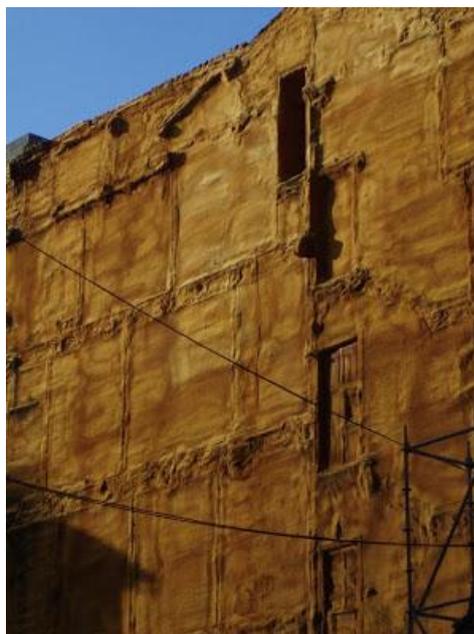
Fachada medianera revestida con espuma de poliuretano.
